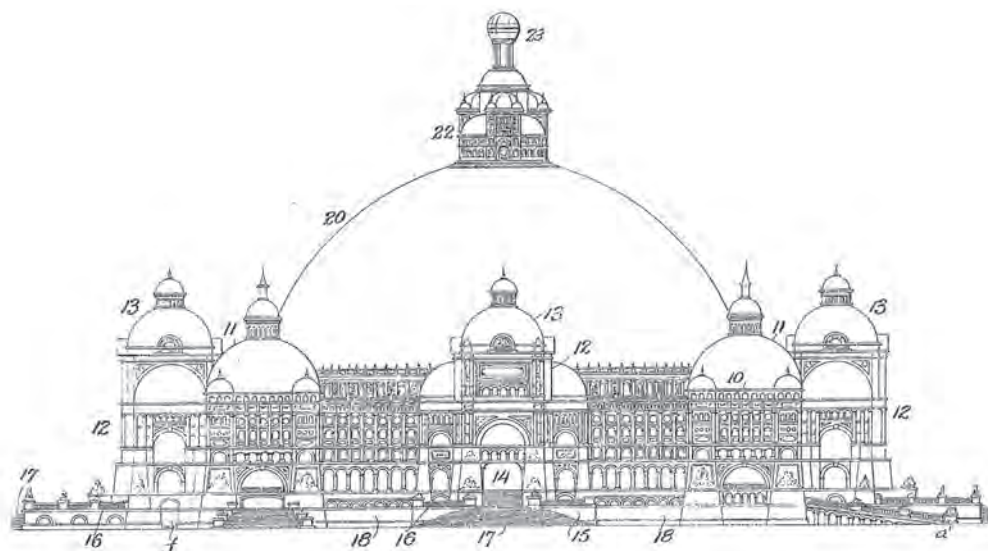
Rafael Guastavino Moreno, 1908. *Structure of Masonry and Steel*, 01.
